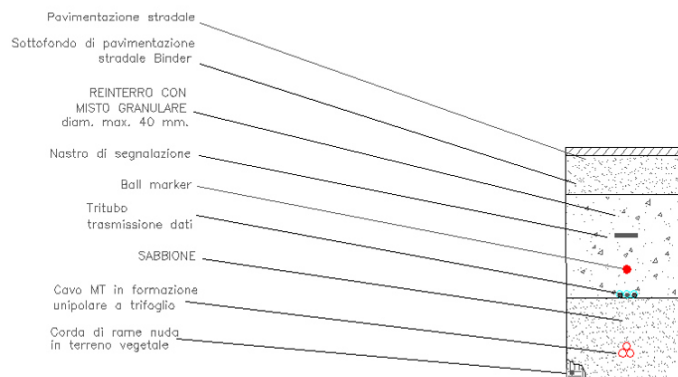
Particolare Posa del cavidotto all'interno del manufatto stradale
